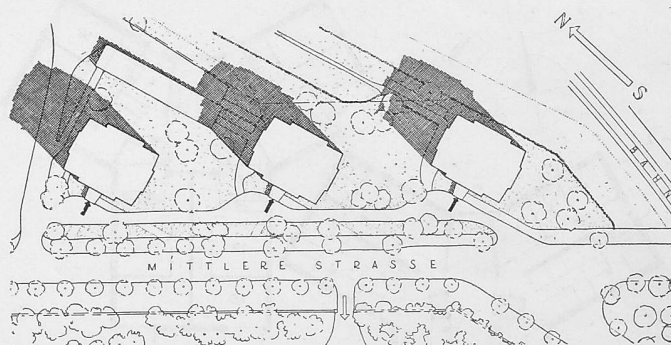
Lageplan der drei Hochhäuser in Basel; 1:2000
